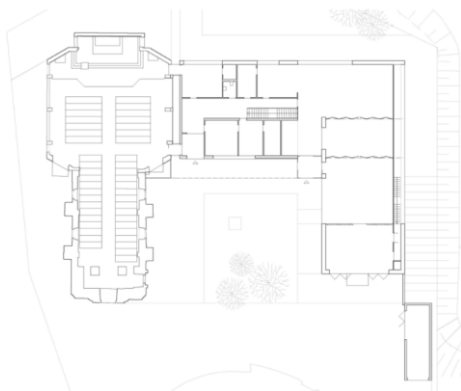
Planta baixa da igreja e do centro paroquial Kirschlag.
